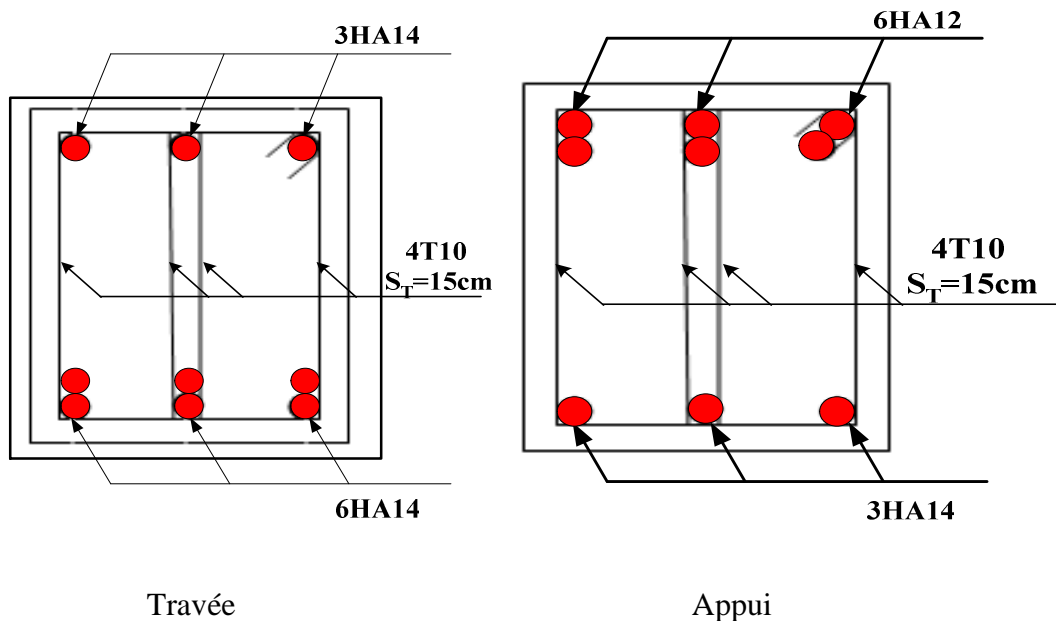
Schéma de ferrailage des poutres principales des entre sol, RDC et les étages courants
